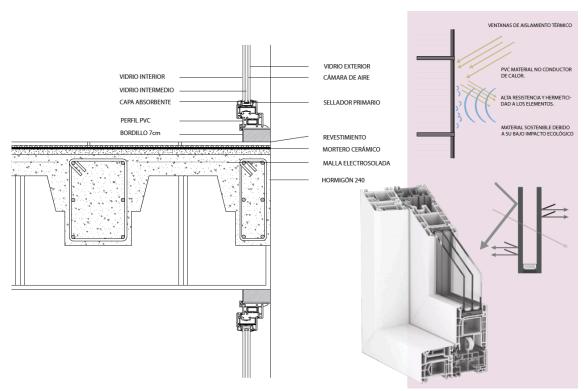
Detalle constructivo aislamiento térmico. Elaboración propia.
